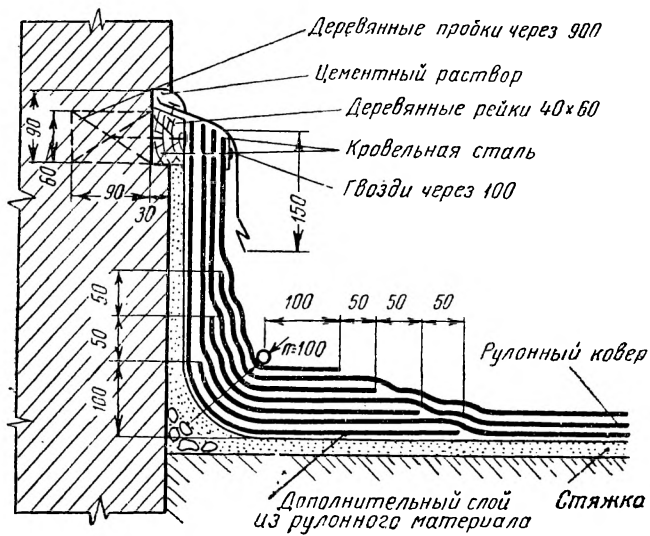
Примыкание рулонного ковра к вертикальной стене
